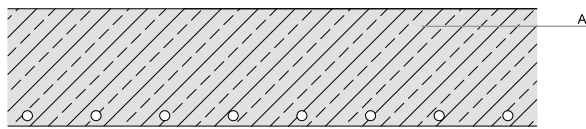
Rohbaudecke aus Stahlbetonbauweise (1a)
